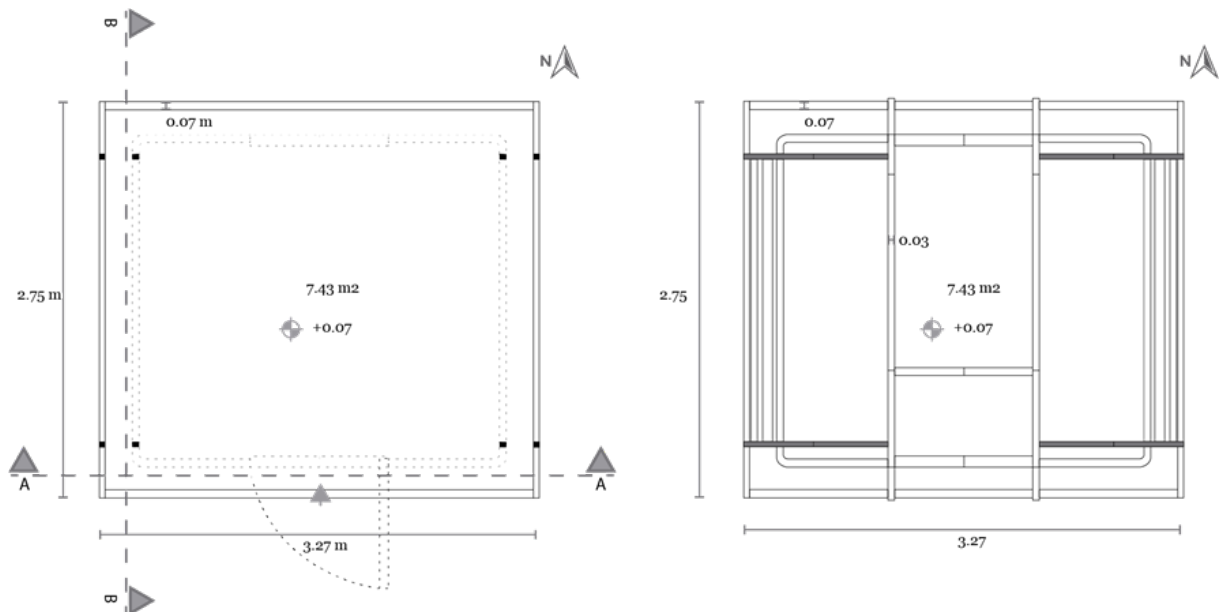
Planta Arquitectónica y Estructural Exo Reaction. Elaboración: Autores. Escala 1:50
